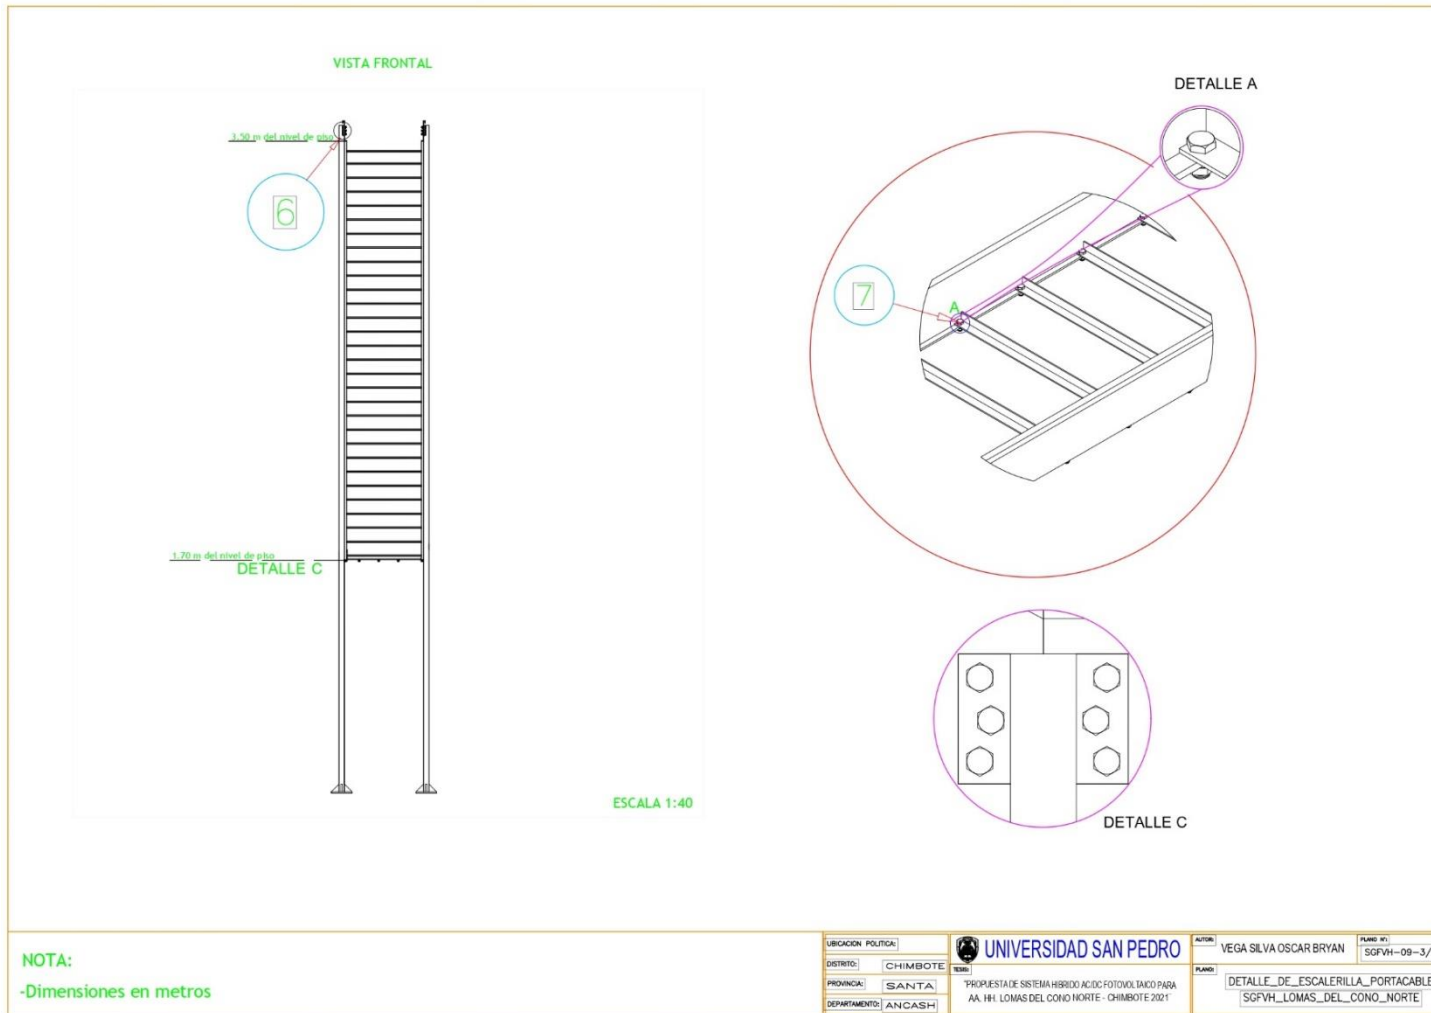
Detalle de Escalera Portacable Vista Frontal_SGFVH.
